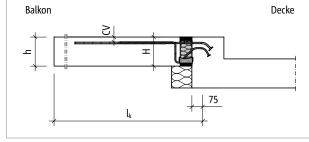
Schöck Isokorb® T Typ KL-U: Statisches System
